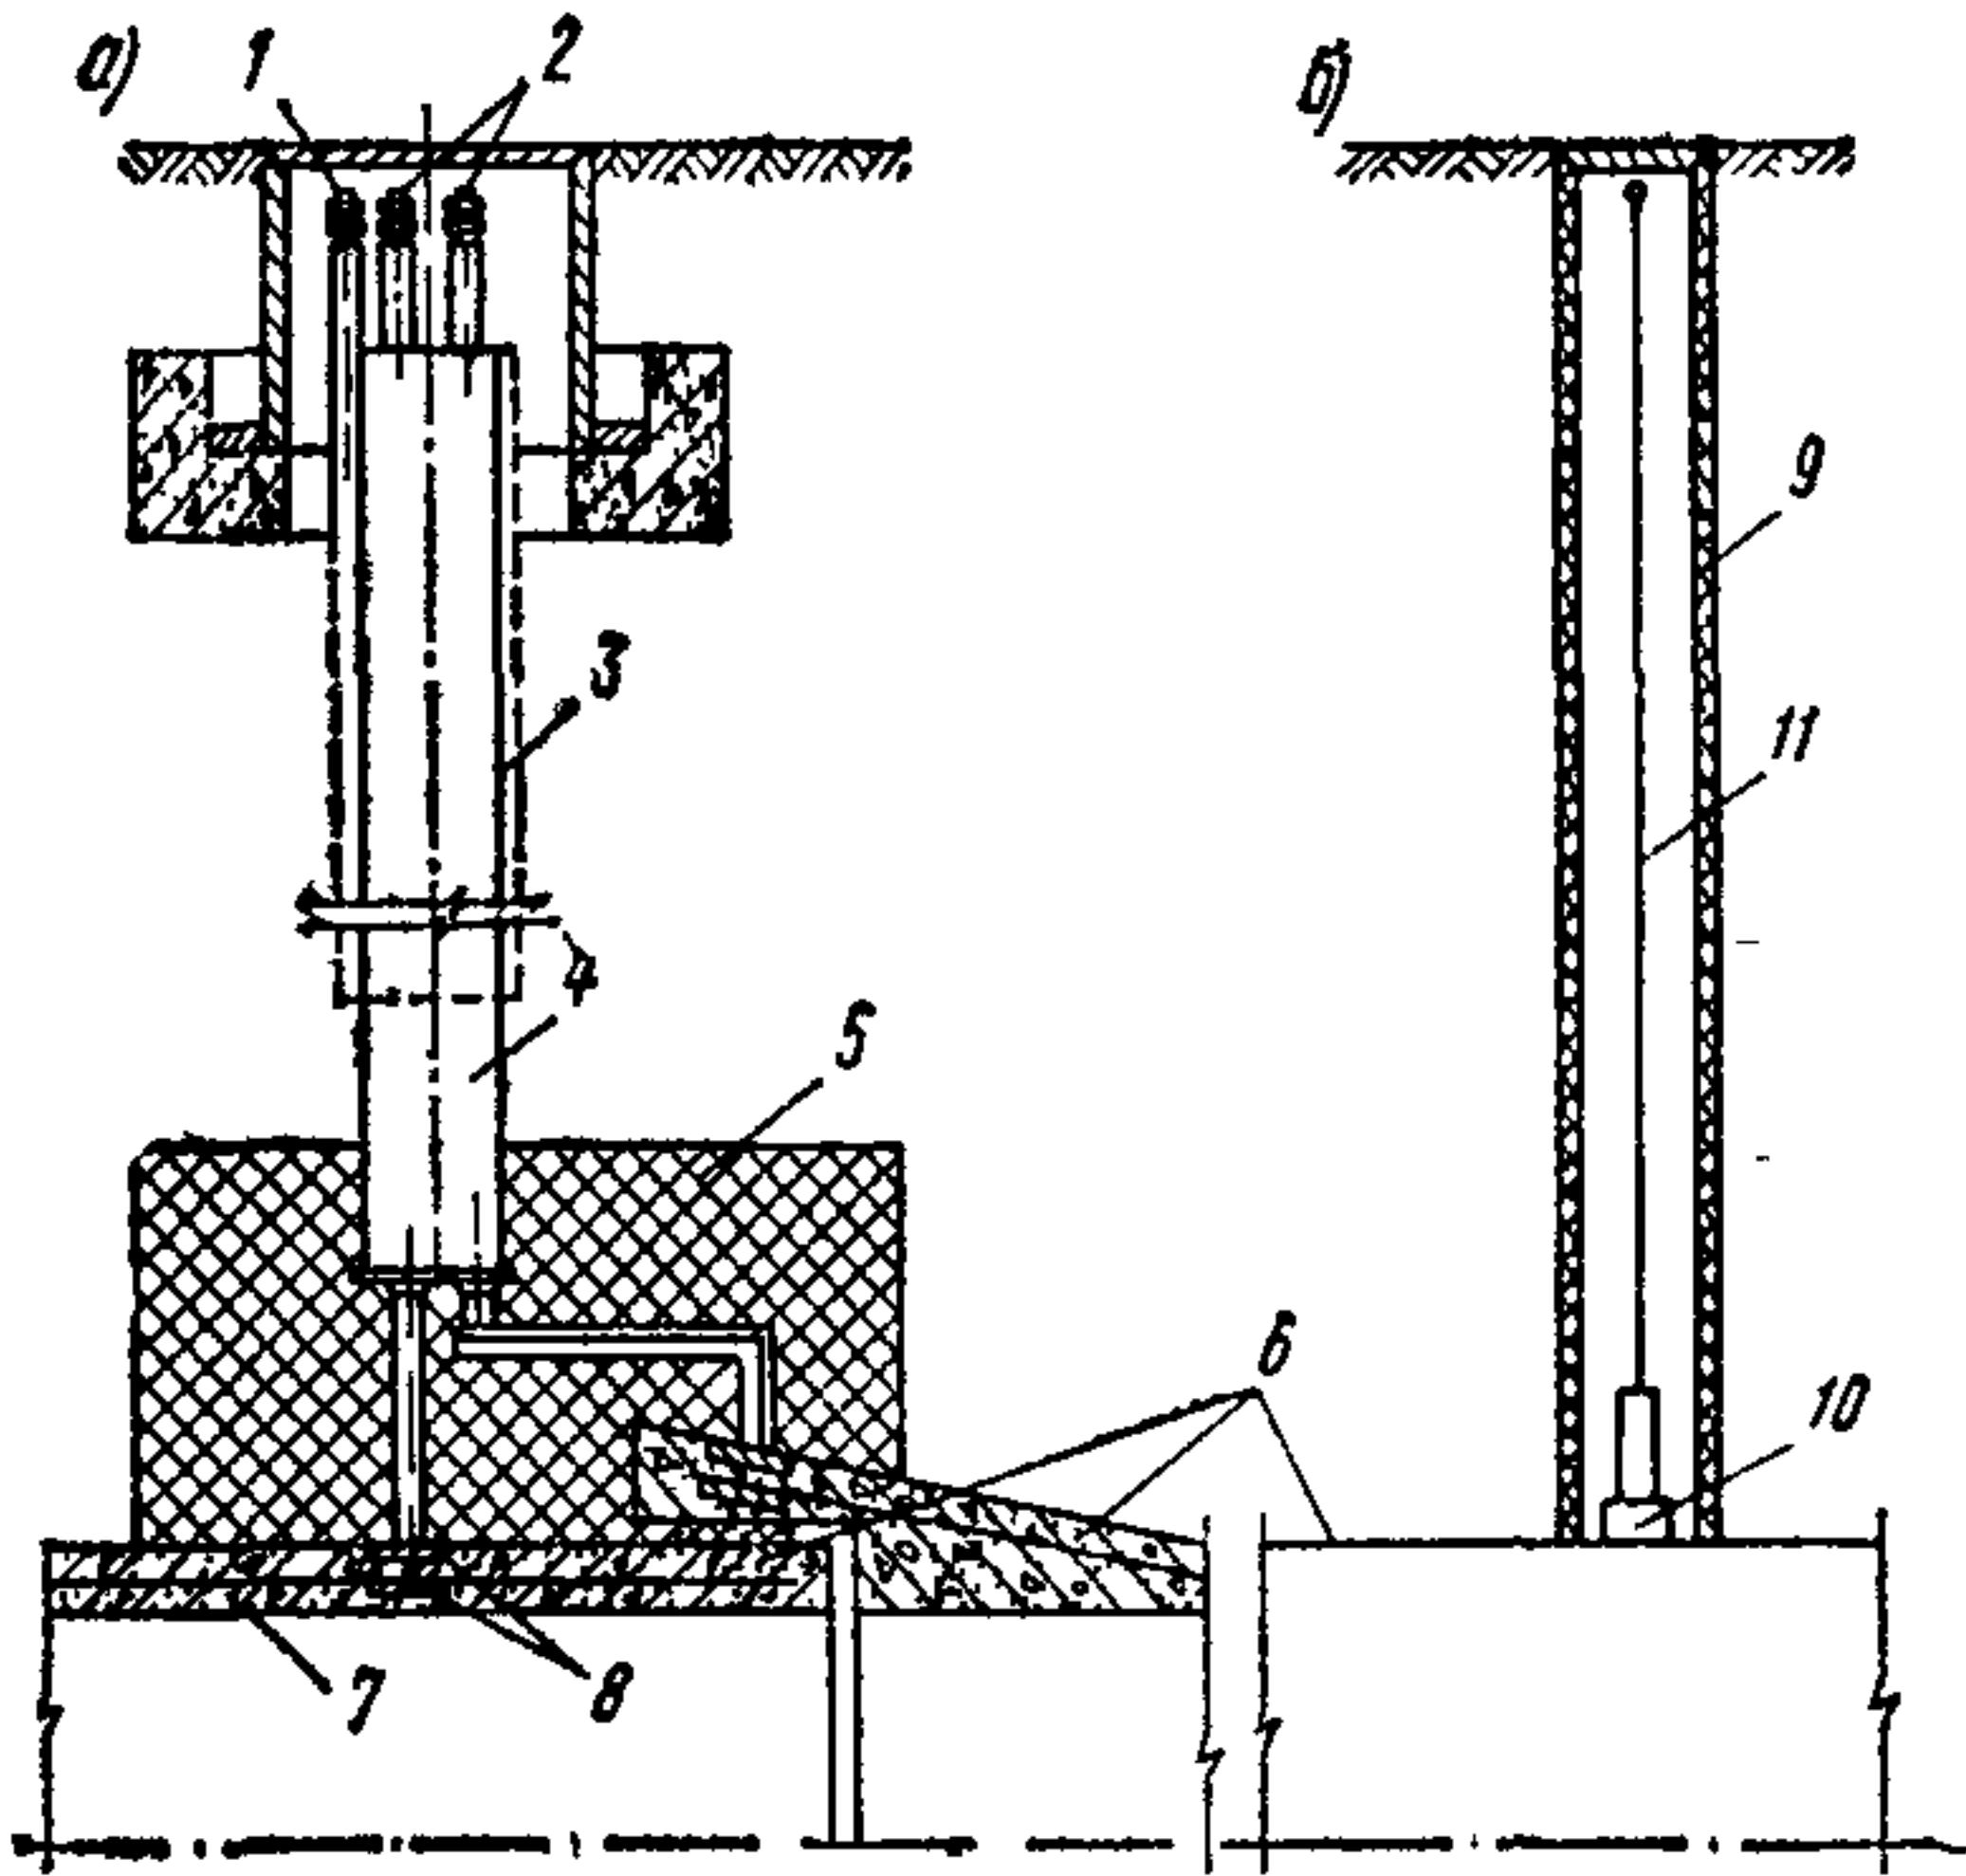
Пример выполнения контрольно-измерительных пунктов для подземных железобетонных трубопроводов
